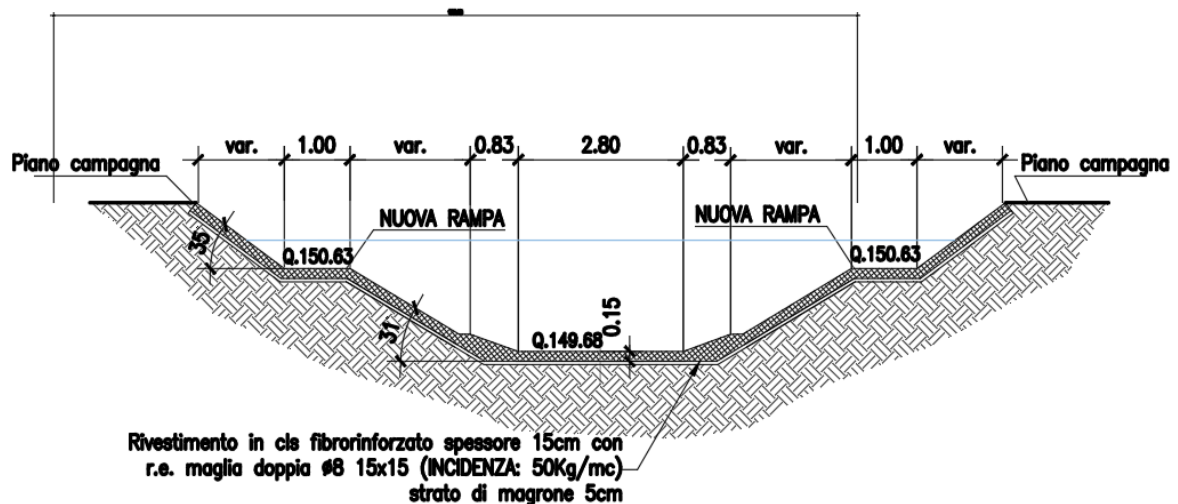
SEZIONE CANALE DI PROGETTO CON STRADELLO
